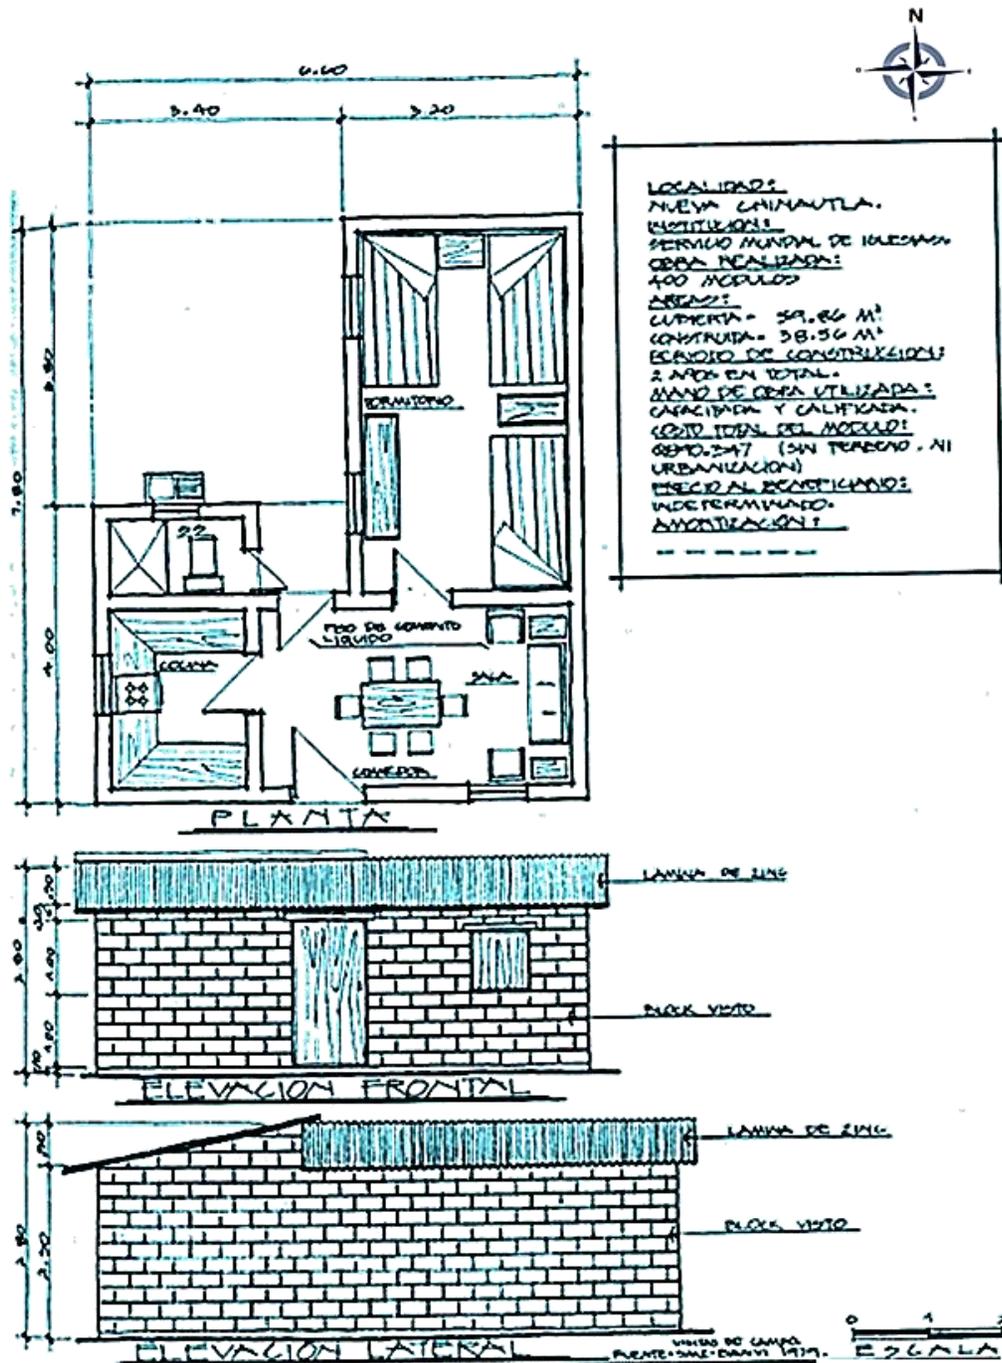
Planta, y elevaciones de vivienda para Aldea Nueva Chinautla, Zona 6 de Mixco. (Marroquín M. Gándara J. 1976, p. 475).
